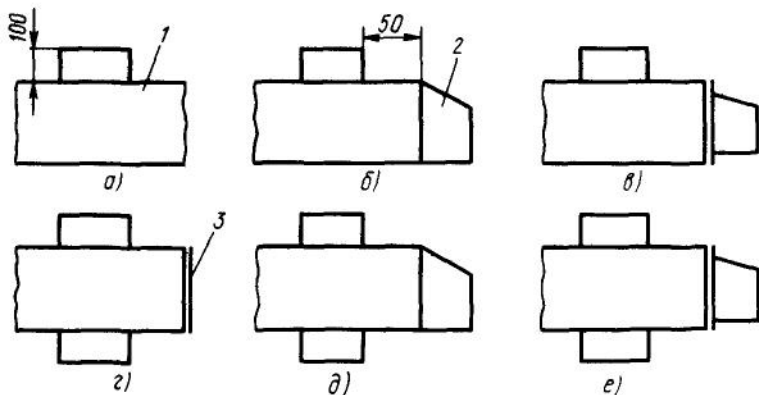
Схемы (а...е) образования узлов отвления воздухопроводов прямоугольного сечения:
